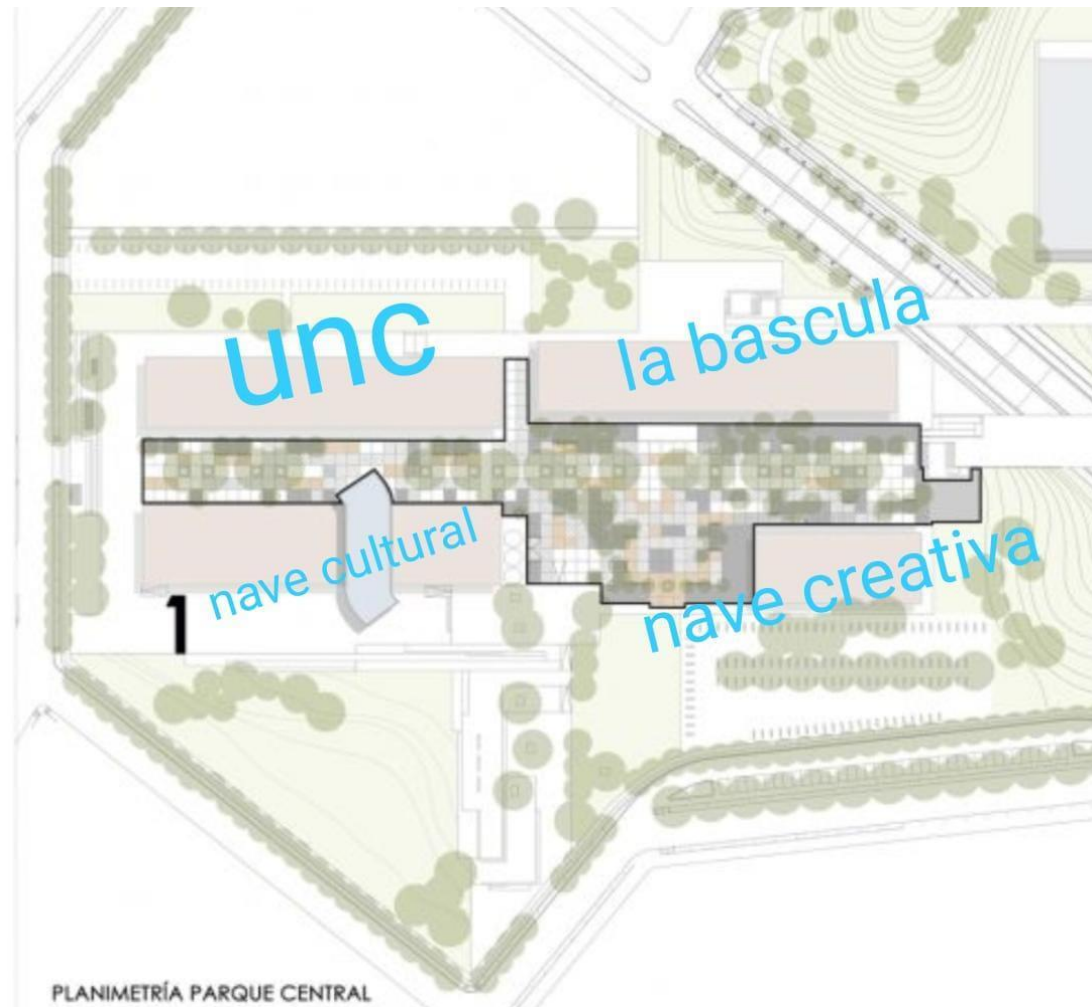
t: Planimetría Parque Central - Ex Estación Central Mendoza. Fuente: Dirección de Obras Públicas. Ciudad de Mendoza. (2019).
